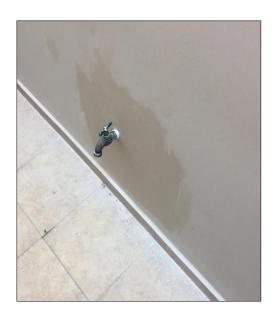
Grifo instalado en su nueva ubicación, a 0.40 m del nivel de piso
